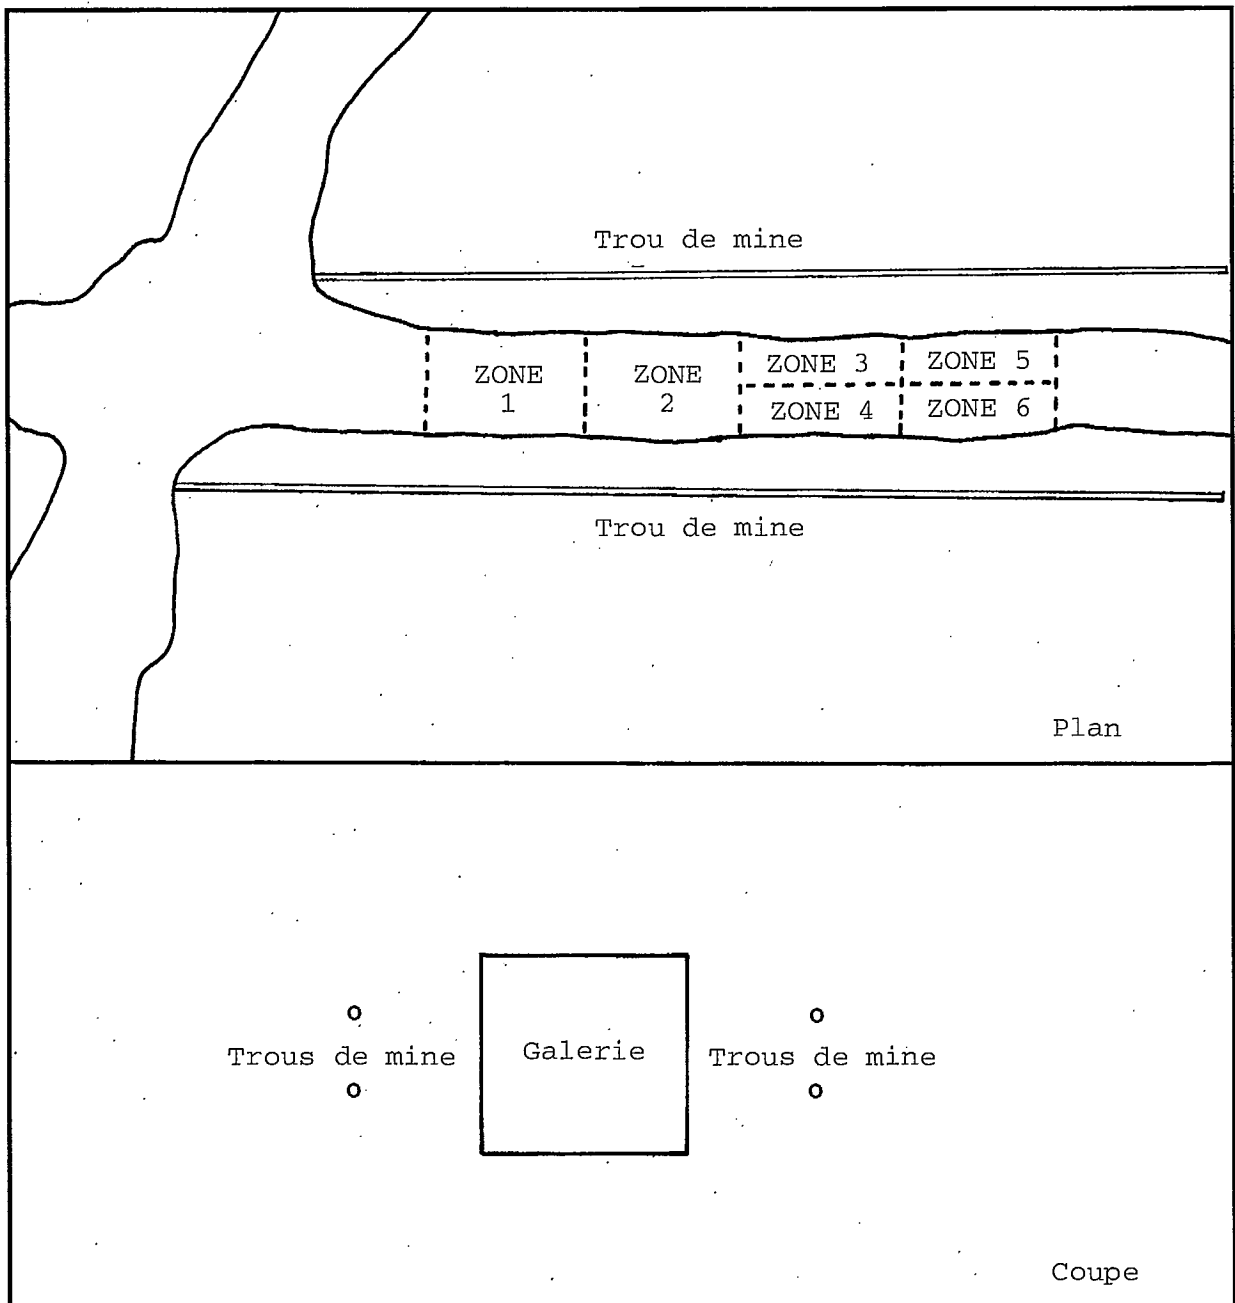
Plan de la galerie et des trous de mines dans les essais de soutènement.
